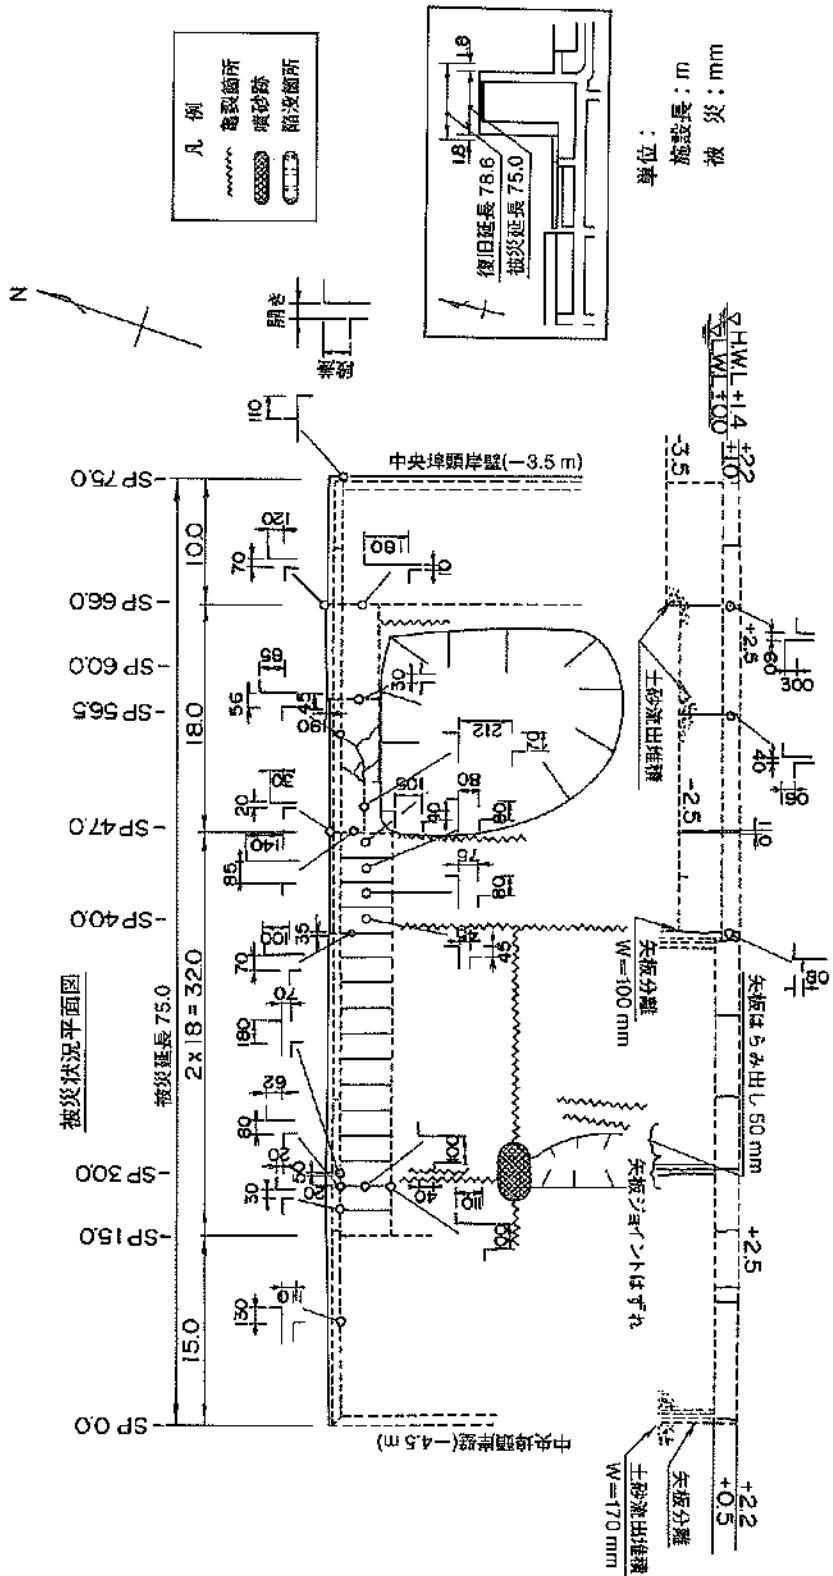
矢板部の詳細平面図 (㊸中央埠頭岸壁取付先端部 東側)
